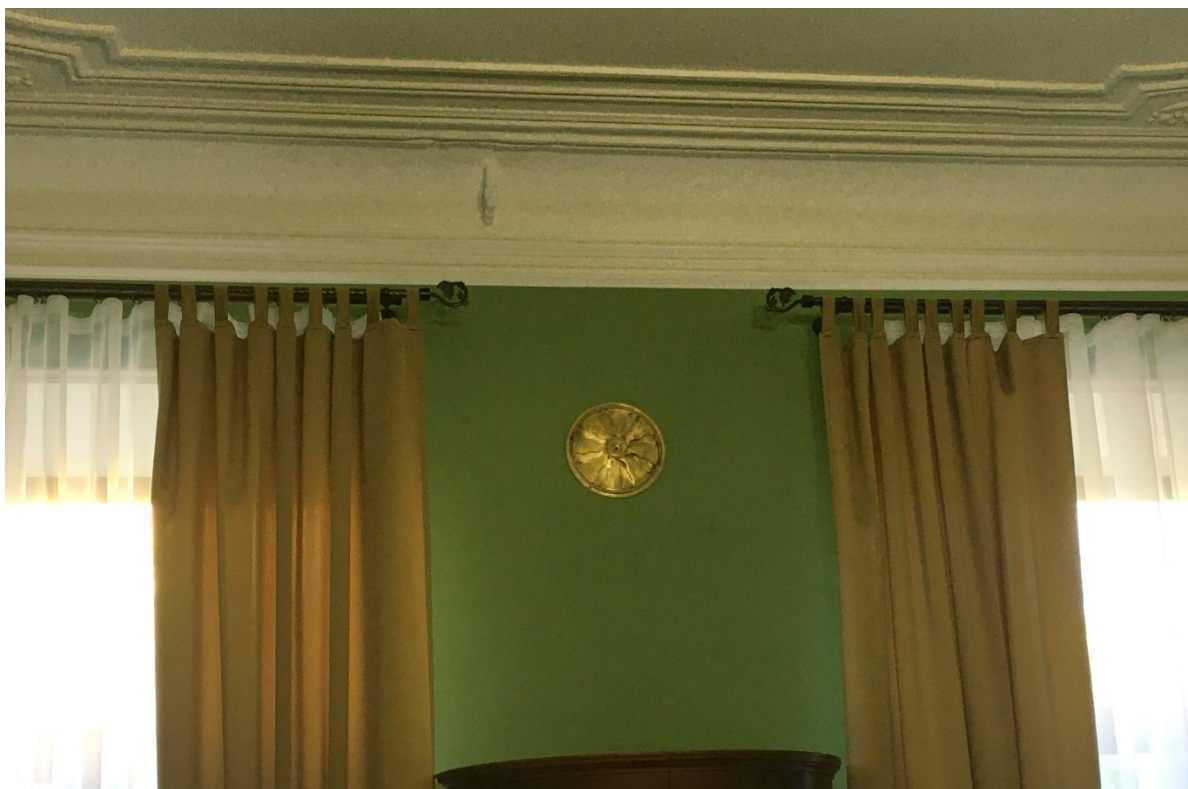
Дверца вентиляционного хода в бывшем помещении №7. Вид с северо-запада
